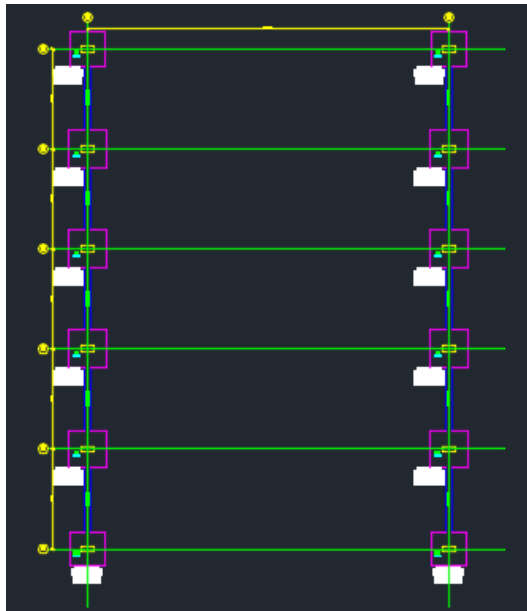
Zapatas tipo I y II Escenario deportivo San Antonio. Fuente: planos estructurales
